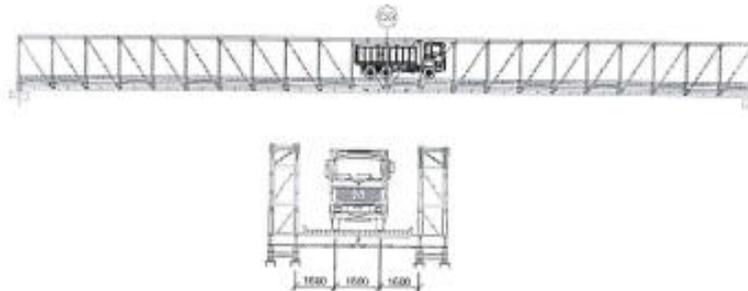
POSICIÓN DE LA CARGA DE ENSAYO (ALZADO Y CORTE TRANSVERSAL)
